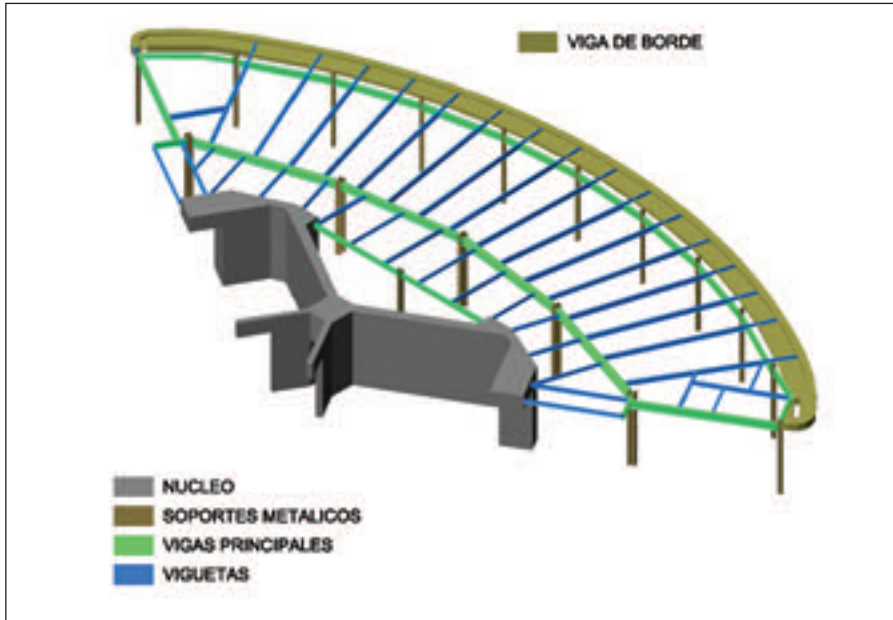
Esquema con la estructura metálica de las plantas tipo.
